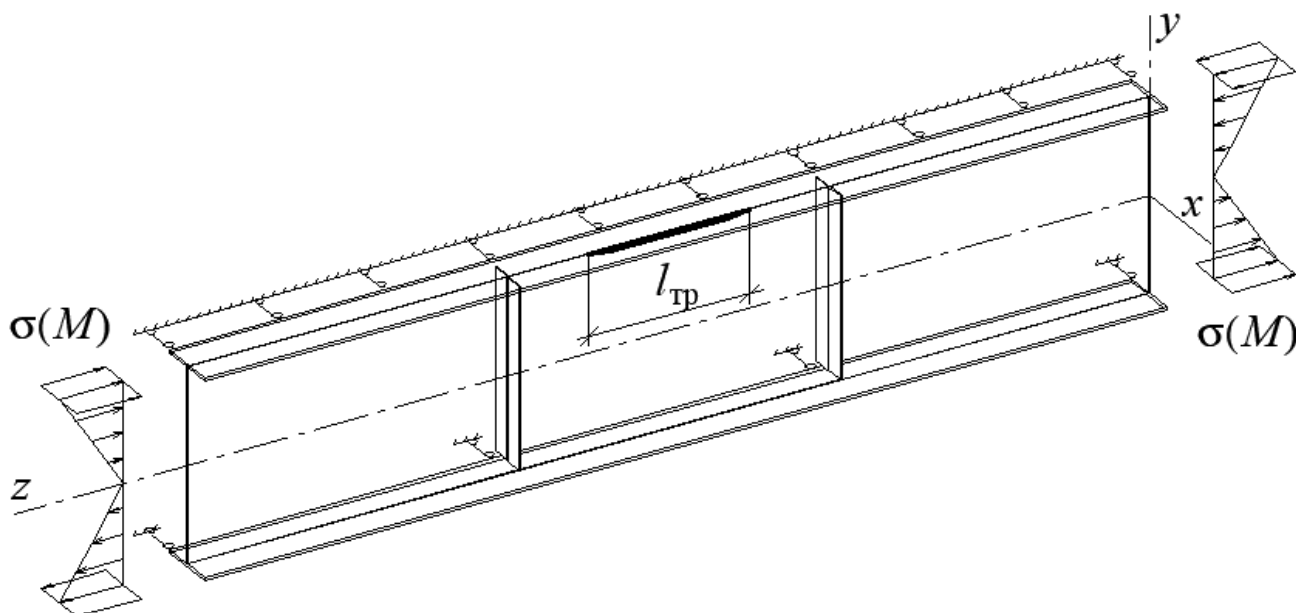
Расчетная схема подкрановой балки с трещиной при чистом изгибе
